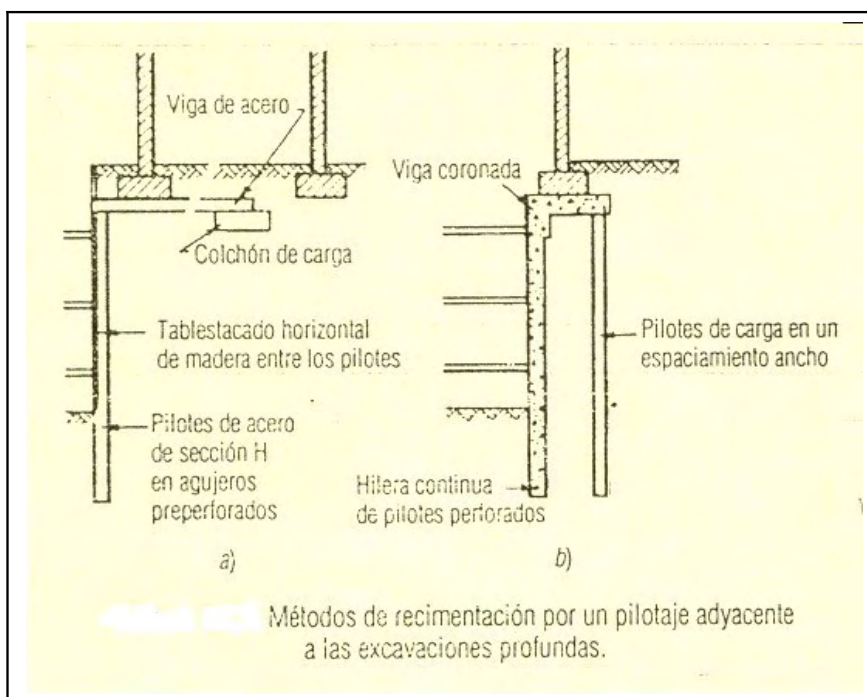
Esquema de recimentación con pilotaje adyacente.
